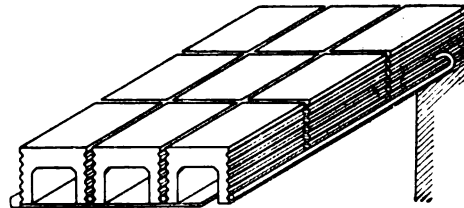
U-Steindecke mit gleichzeitig gestampfter Bimsbeton-Putzdecke.
